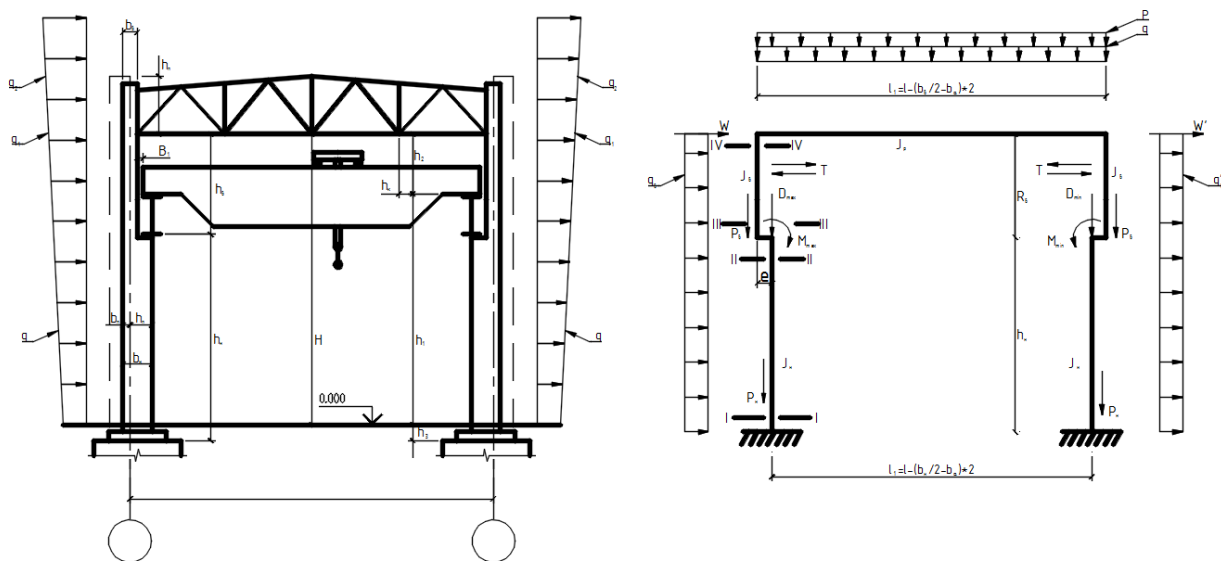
Поперечный разрез здания(а) и соответствующая ему расчётная схема (б)
